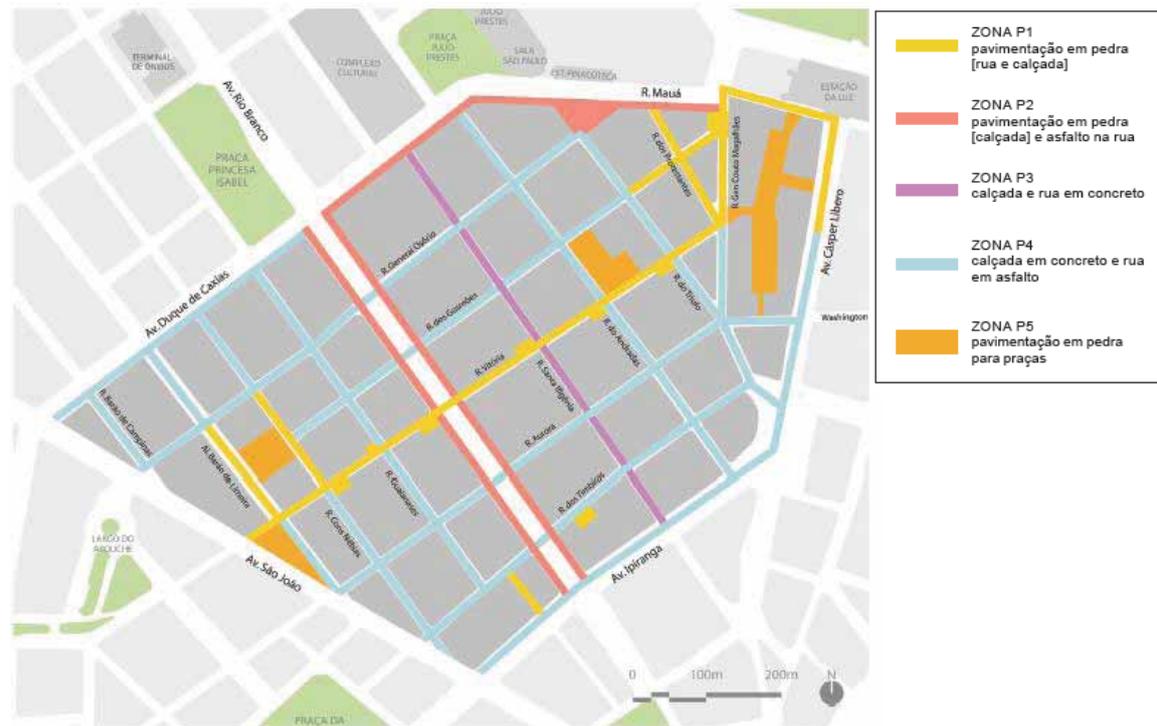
PLANTA DE PAVIMENTAÇÃO
